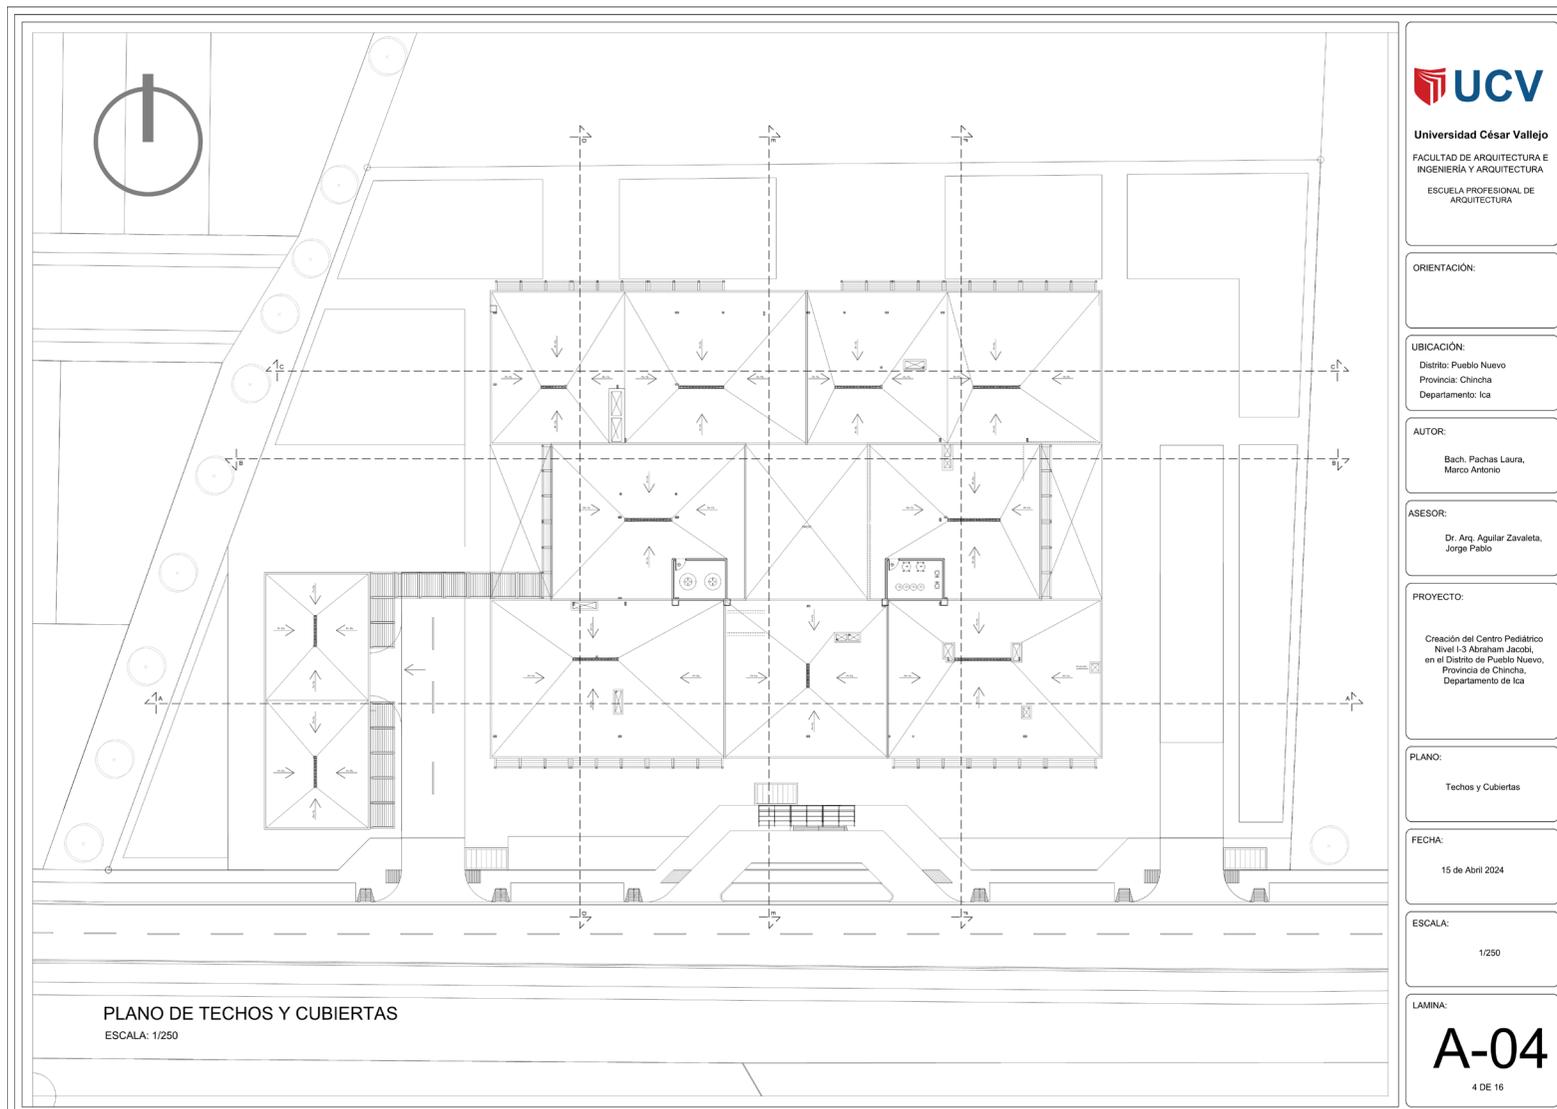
A-04 Plano de techos y cubiertas. Fuente: Elaboración propia.
